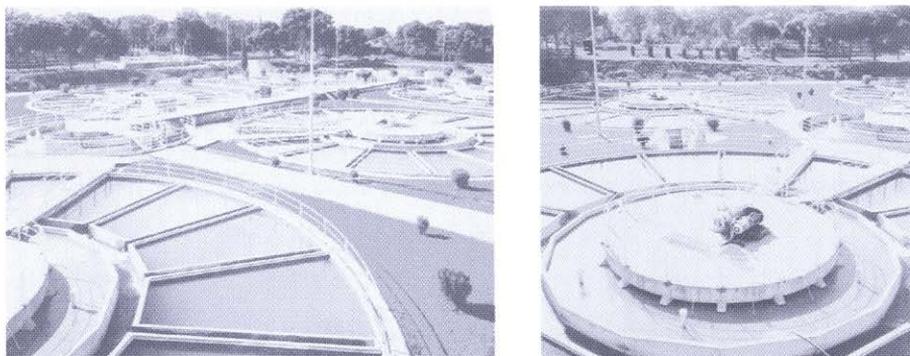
Planta potabilizadora de Casablanca. [Zaragoza]
